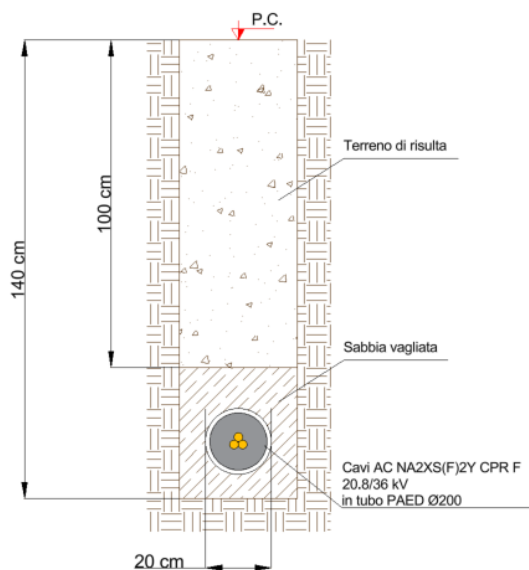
Sezione tipica di scavo per posa cavidotto BT di collegamento Skid di trasformazione – cabina di raccolta 36 kV
